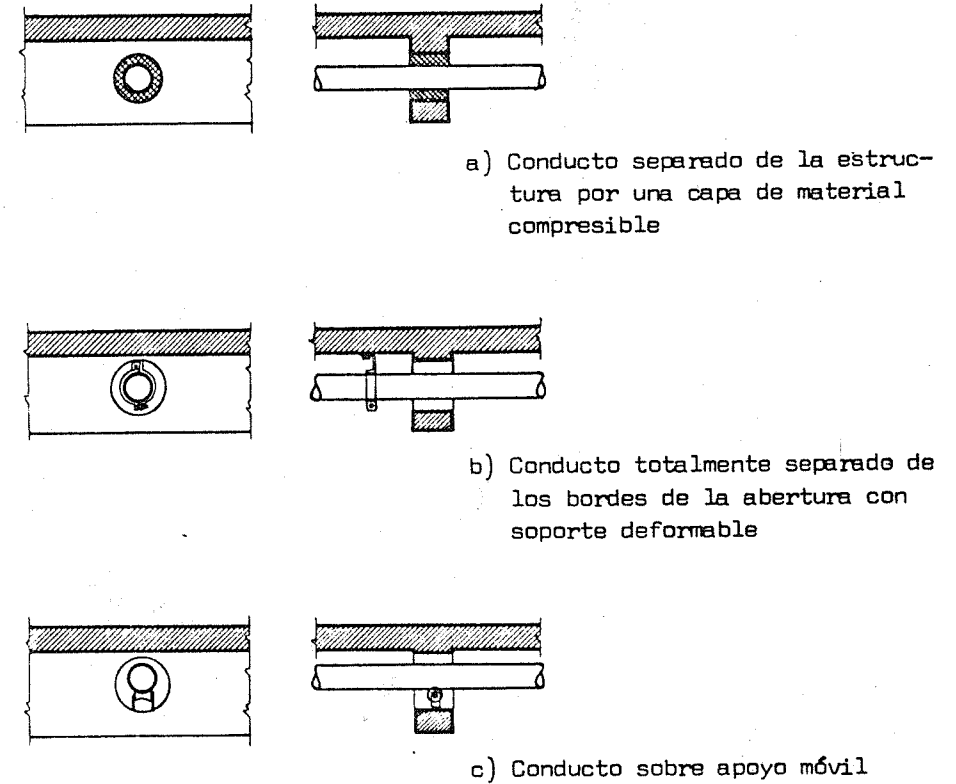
Distintos tipos de fijaciones para los conductos
